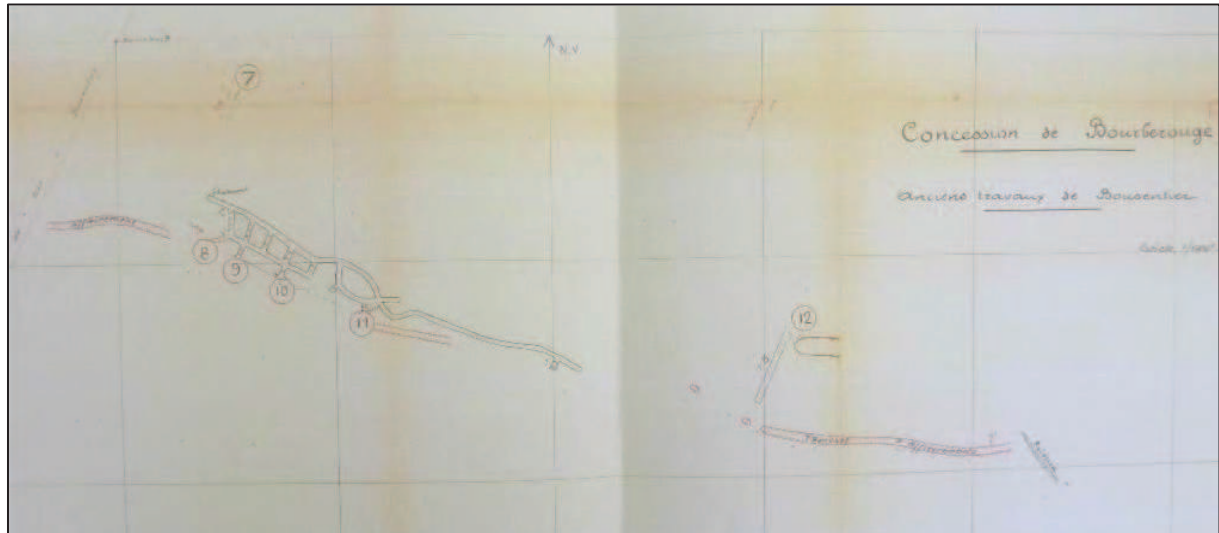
Plan de l'exploitation souterraine de Bousentier [39]
